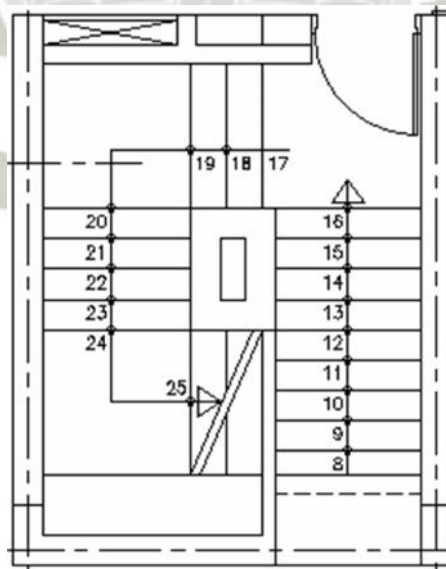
Vista en Planta de Escalera del Primer Nivel.
